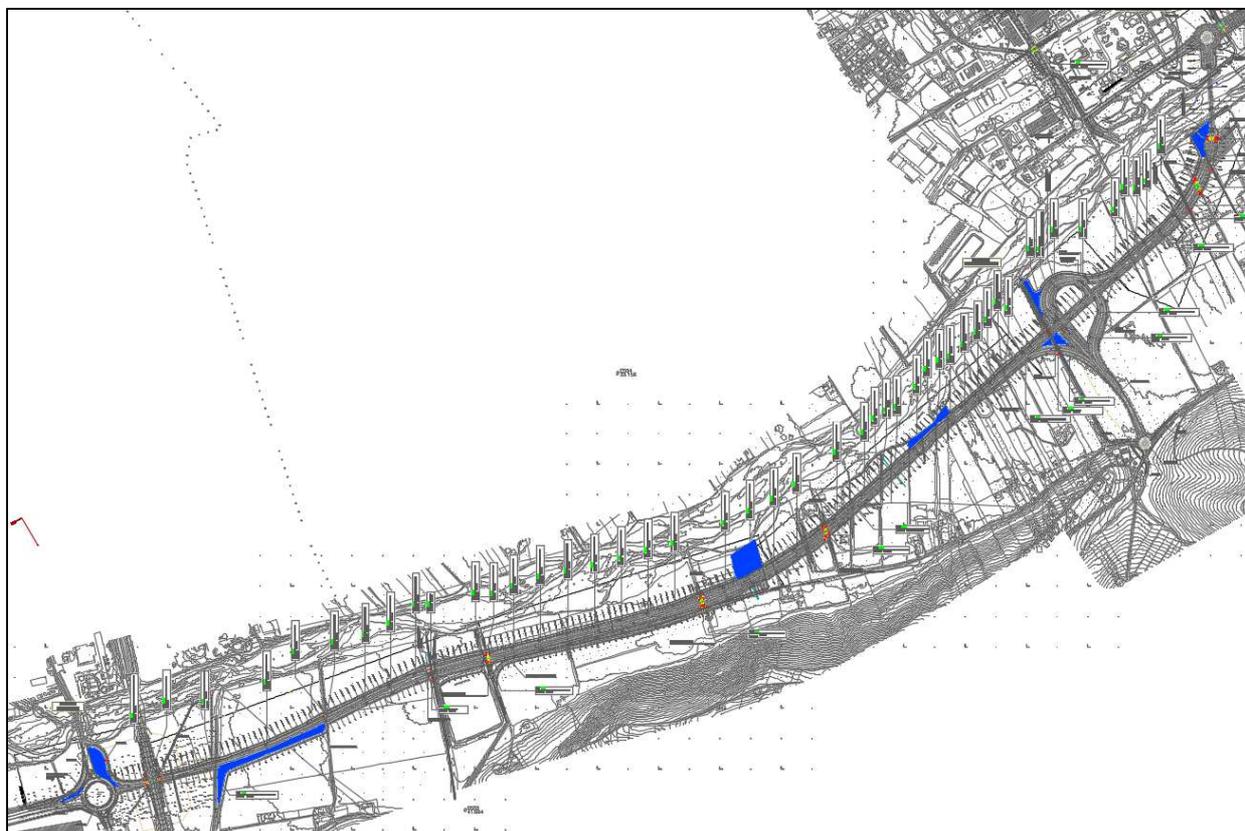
Stralcio planimetrico localizzazione PF1 (aree blu)
